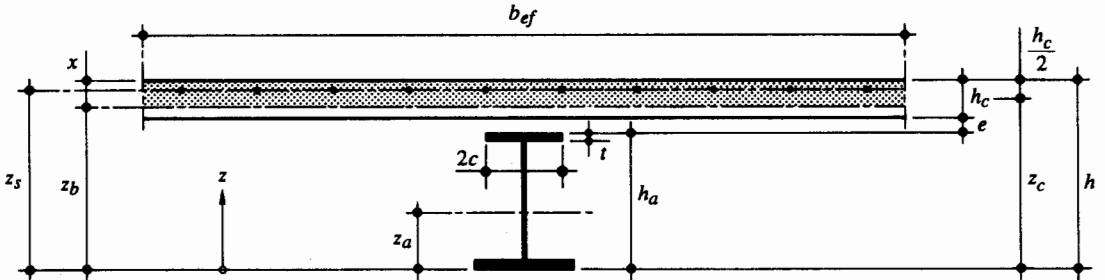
Notations et conventions adoptées pour une section mixte.
